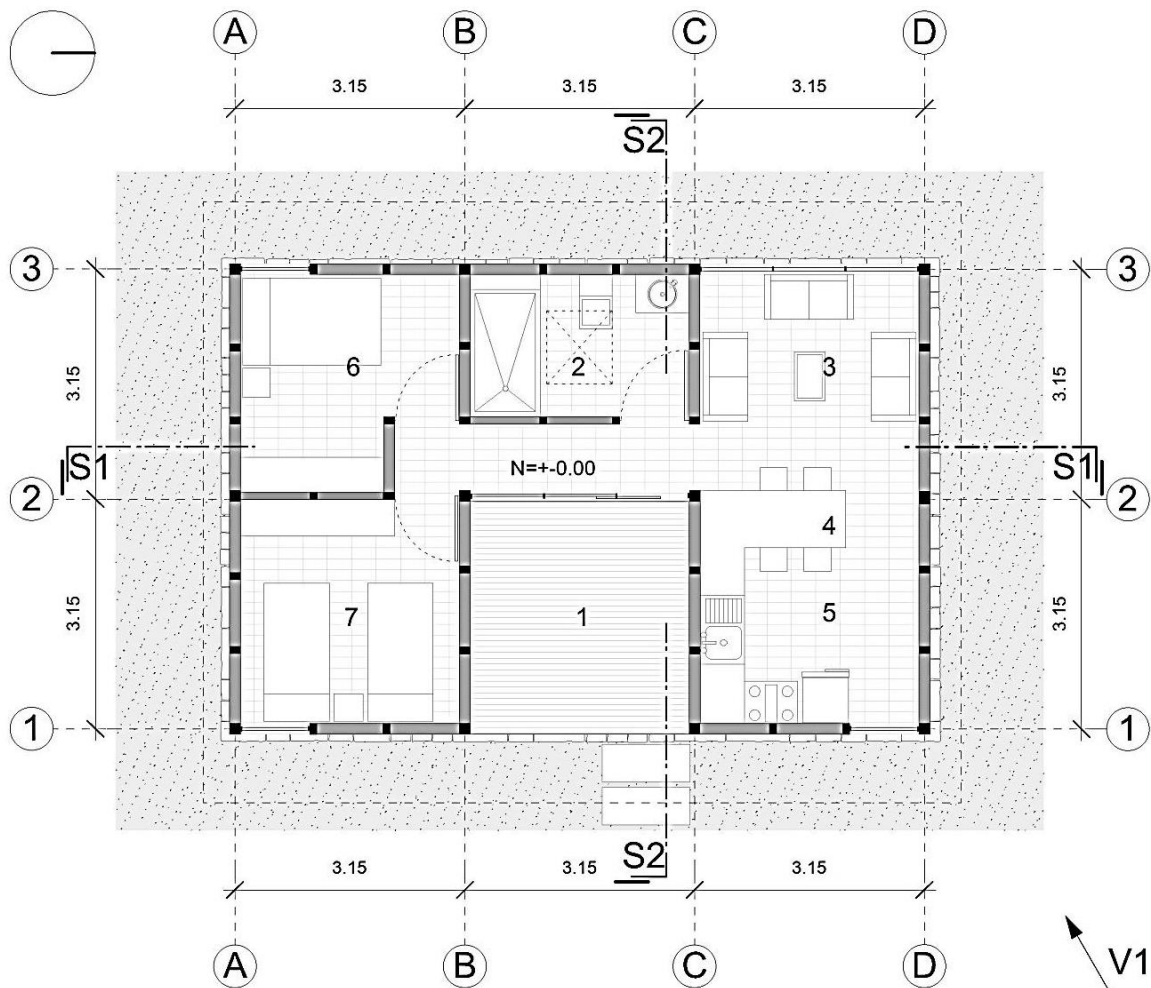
Planta Arquitectónica de la vivienda propuesta, escala 1=100. Autor: Paúl Rivas Rivas.
